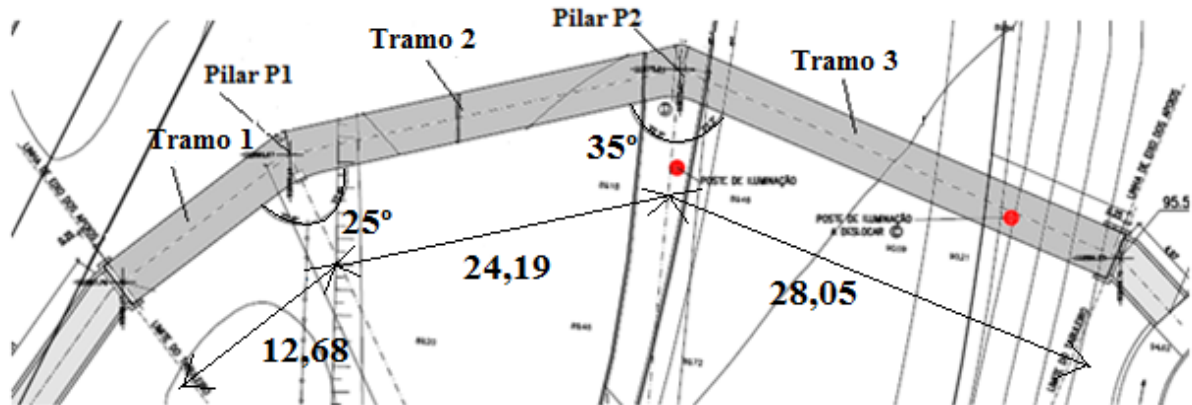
Traçado do tabuleiro concebido com viga Vierendeel [25].
